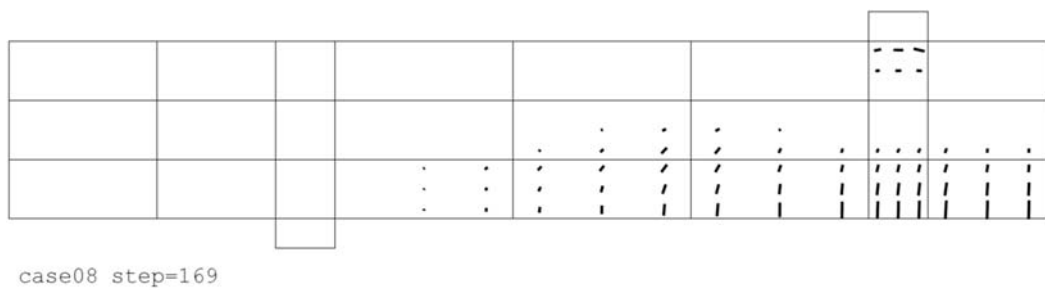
破壊時の変形及びひび割れ状態 (CaseNo. 8)
